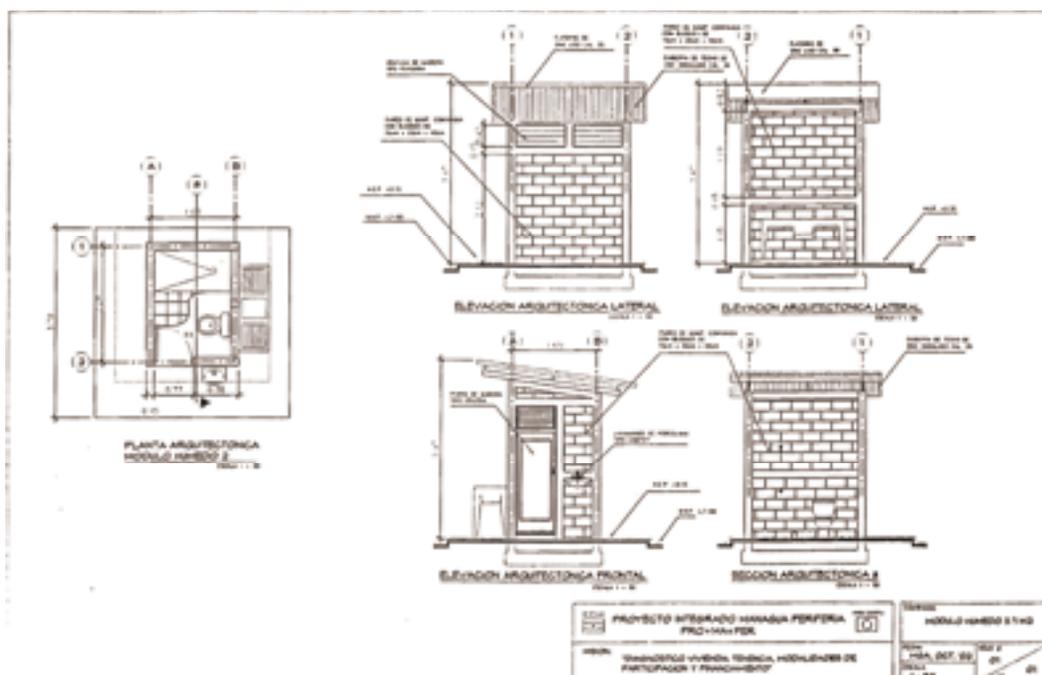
En el plano se muestra la unidad de obra “Modulo húmedo: inodoro, lavabo y ducha con lavadero de hormigón en el exterior”. La resolución formal y material de cada uno de los 400 proyectos, se facilitó mediante la preparación de hasta 23 opciones de unidades de obra elementales o elementos funcionales, definidos en forma prolija: mediciones, detalles constructivos acotados, presupuesto, mano de obra necesaria —número y tipo—, etapas de ejecución...
